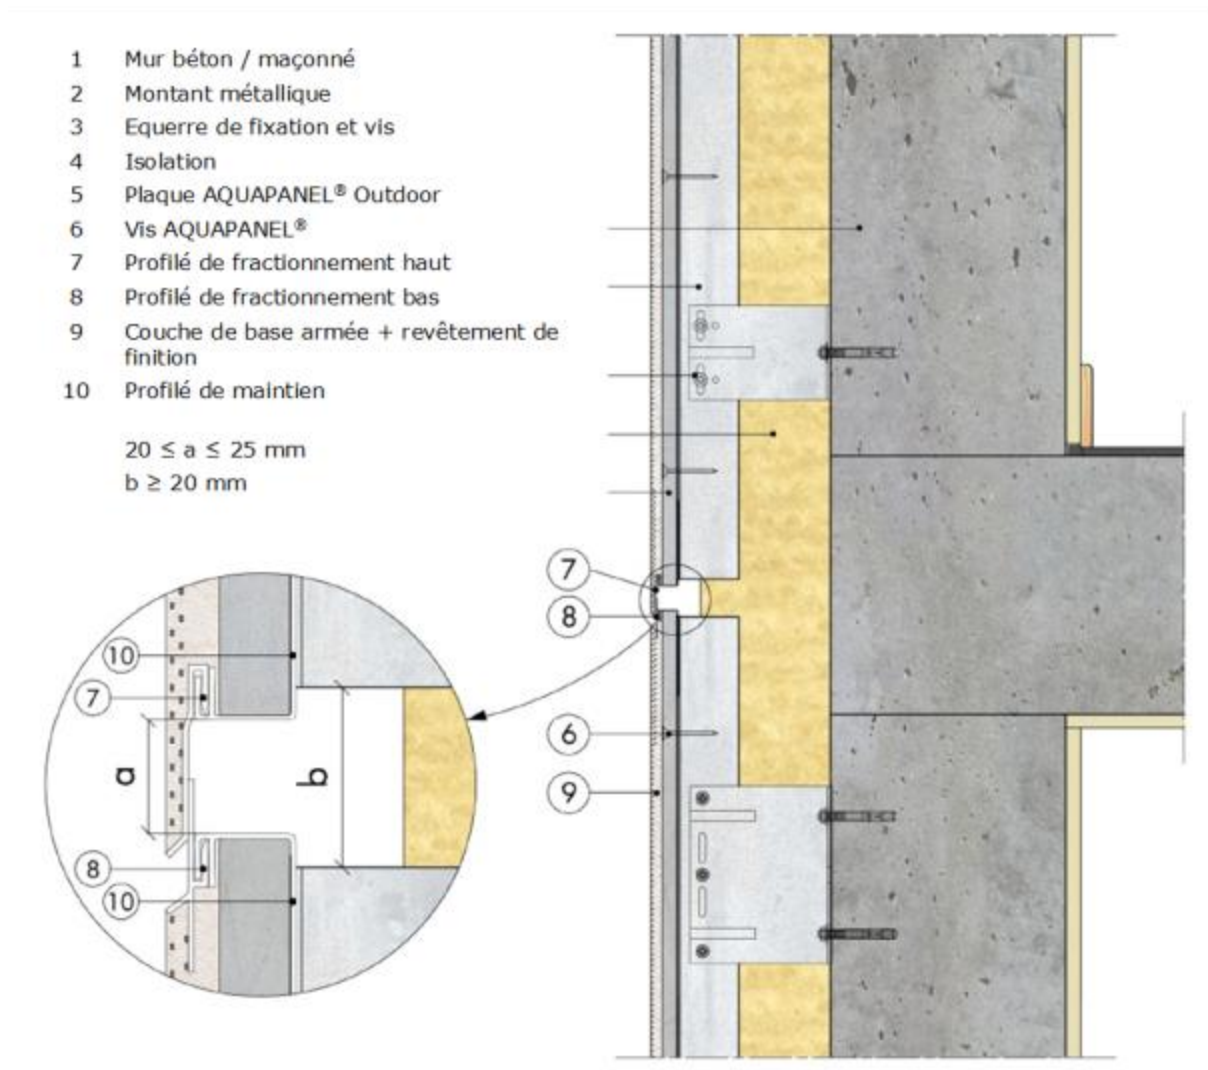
Joint de fractionnement horizontal sur ossature librement dilatable – Coupe verticale
